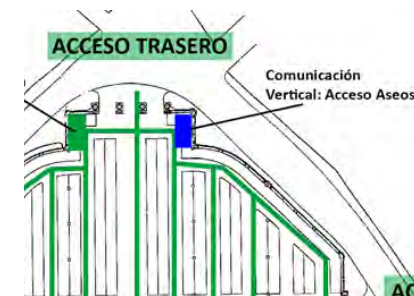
Plano detalle de la ubicación de la zona de comunicación con la planta sótano
